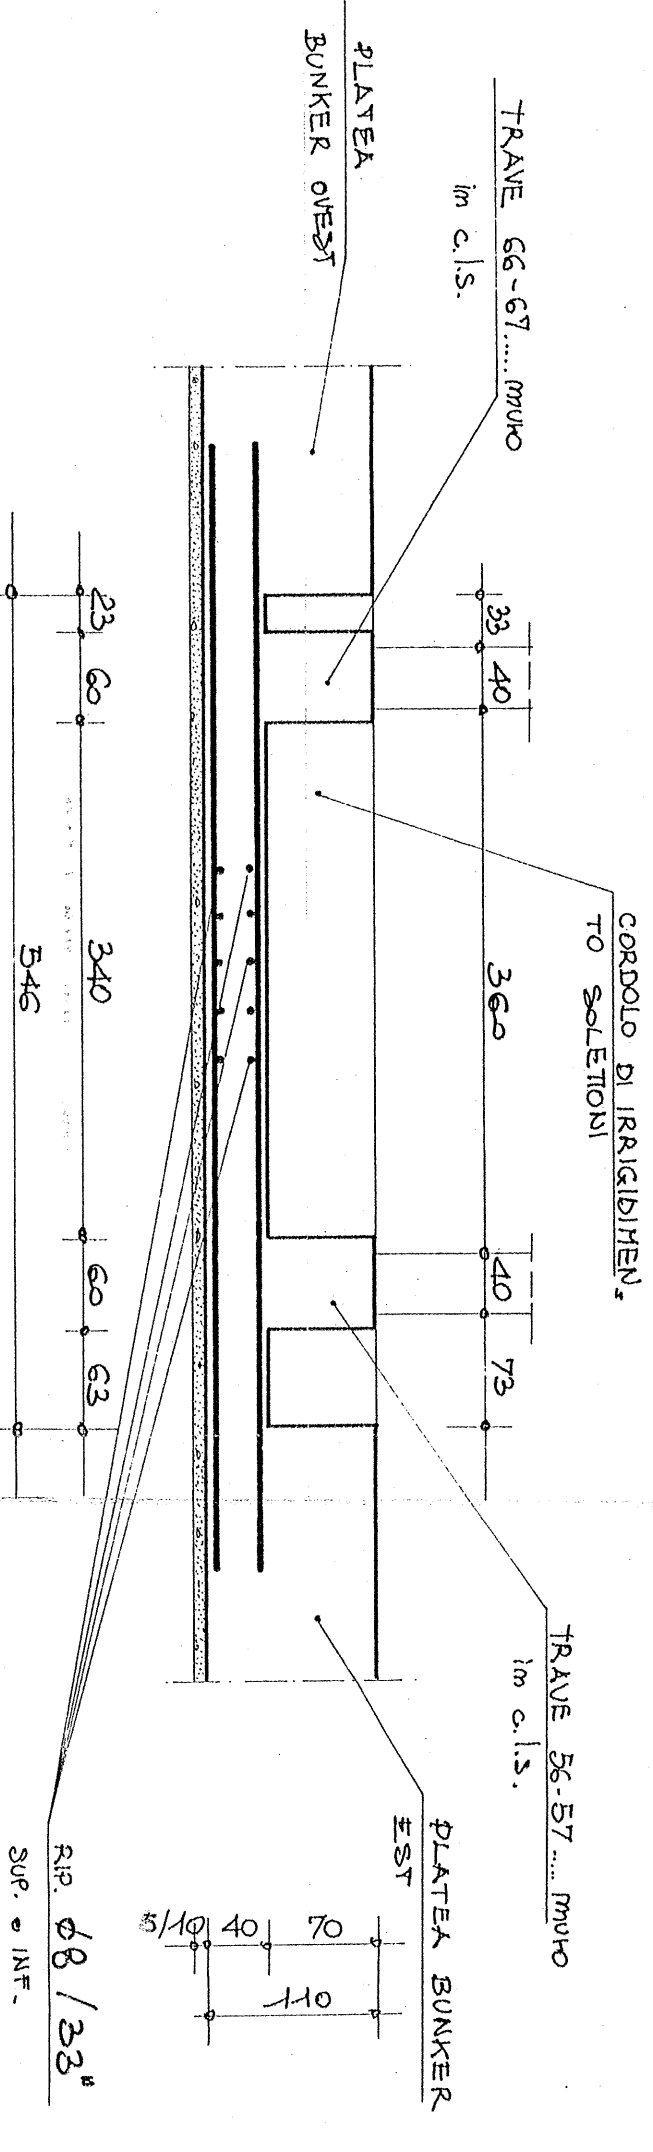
PLATEA DI FONDAZIONE E ARMATURA BUNKER EST - 10.50 -
